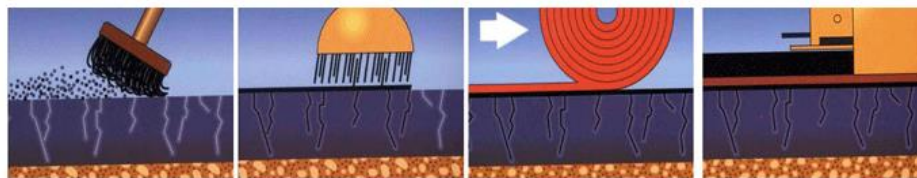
Empleo de geotextil entre capas asfálticas.
